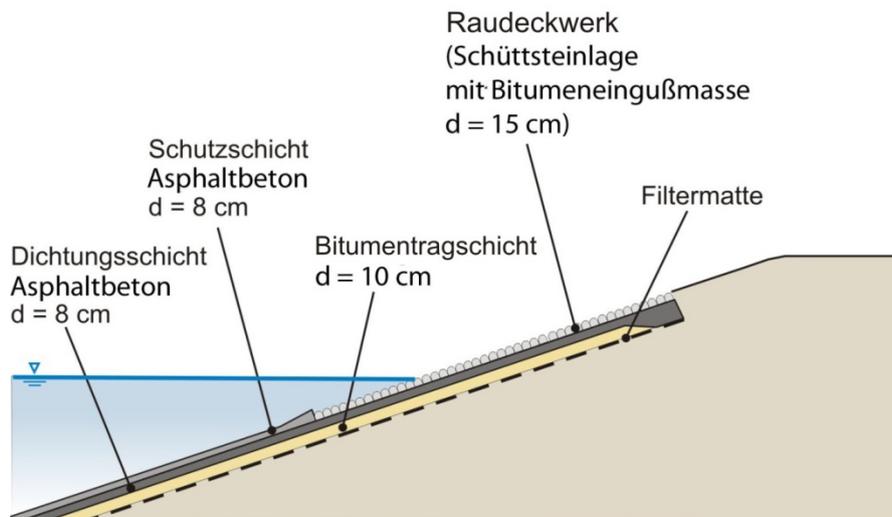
Beispiel Aufbau Asphaltdeckwerk
